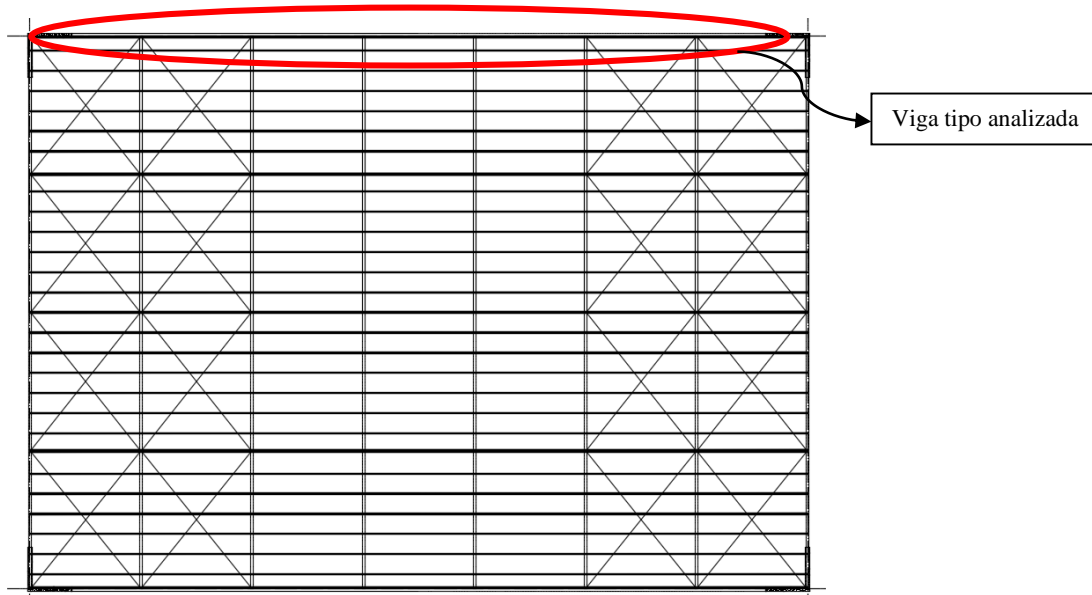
Ubicación en planta de la viga reticulada tipo analizada.
